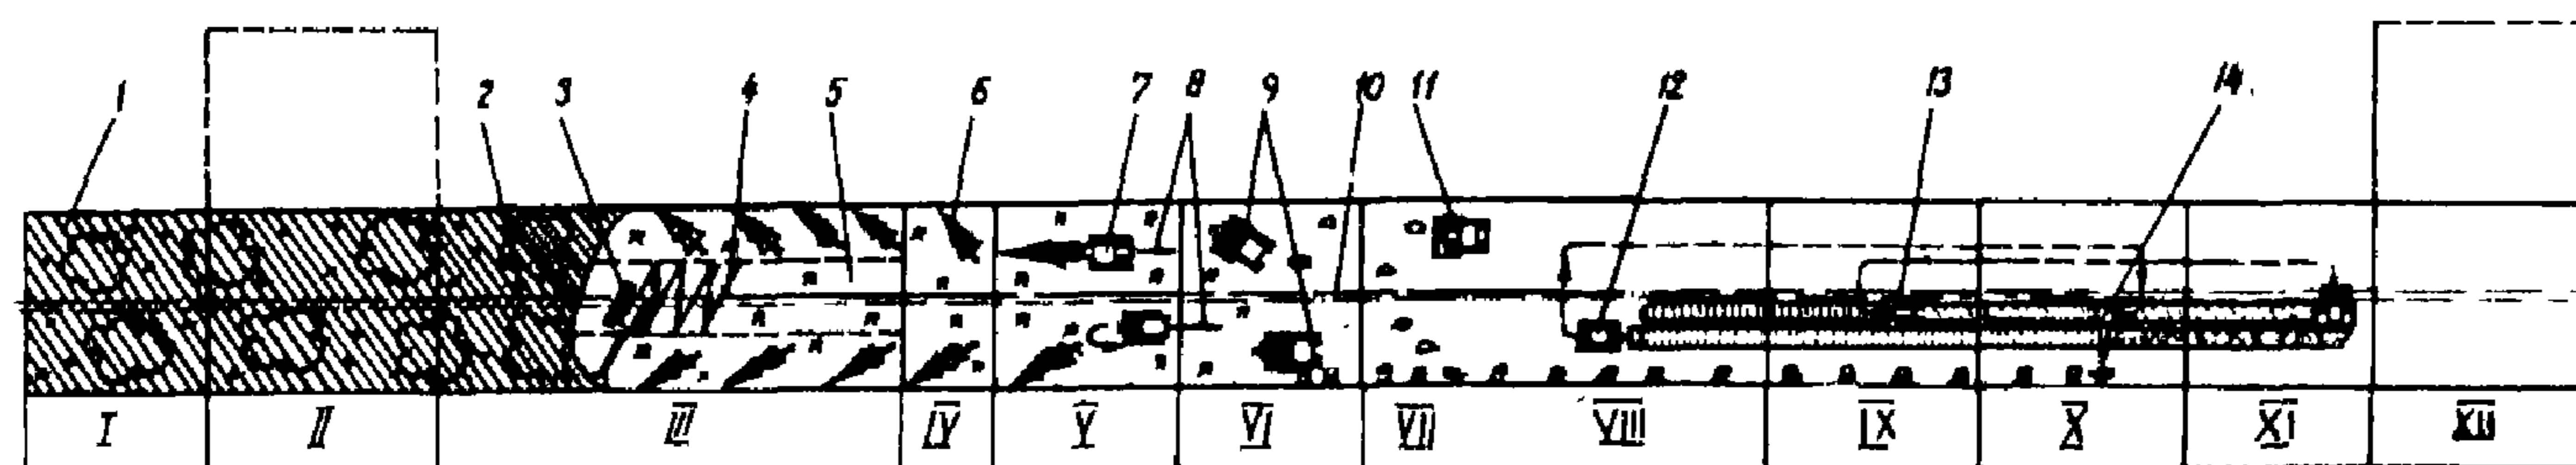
Технологическая схема расчистки строительной полосы от леса лесоповальной машиной ЛП-19 на устойчивых минеральных грунтах:
